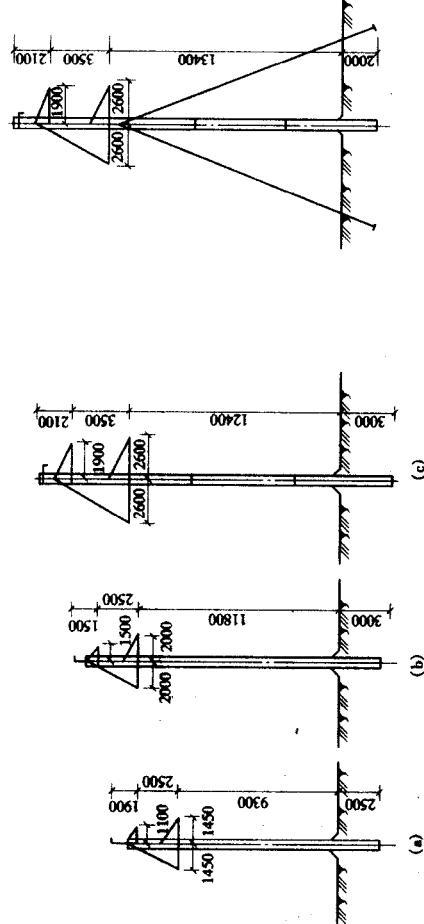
35~110kV 钢筋混凝土 A 型单杆电杆
